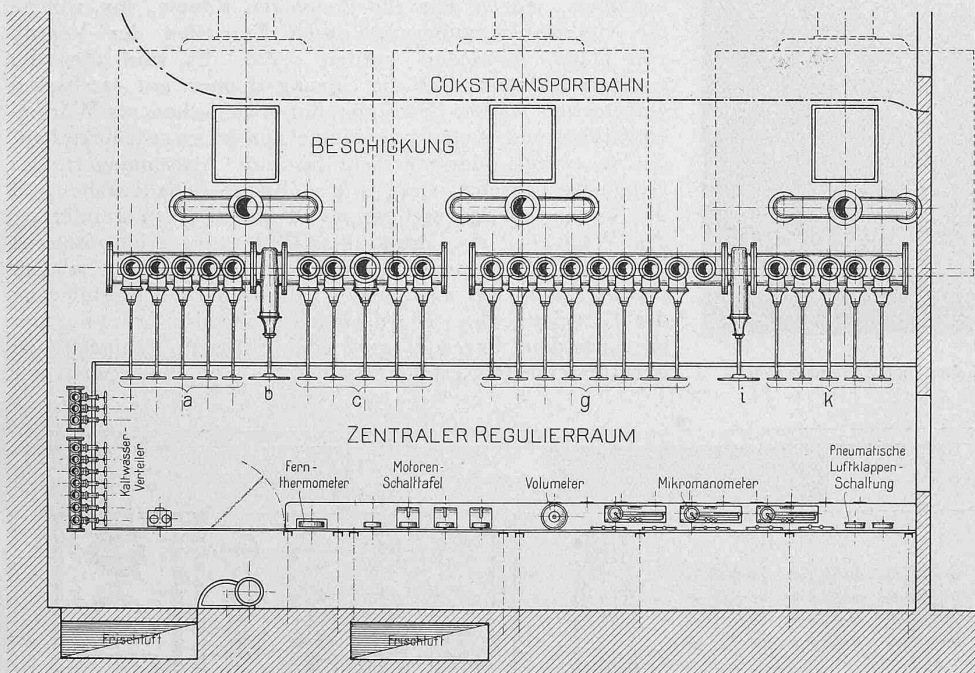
Grundriss des Zentral-Regulierraums über dem Kesselraum. — 1 : 50.
